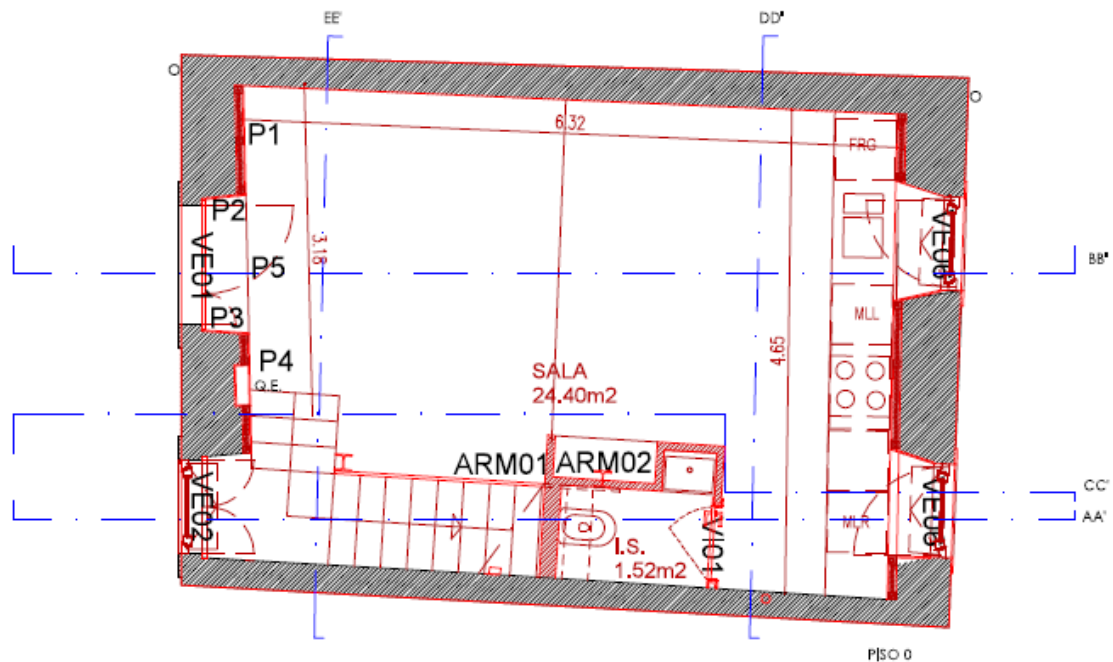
projeto de arquitetura piso 0 (Seleiro, Cruz, & Sandra, proposto planta dos pisos, 2017)
